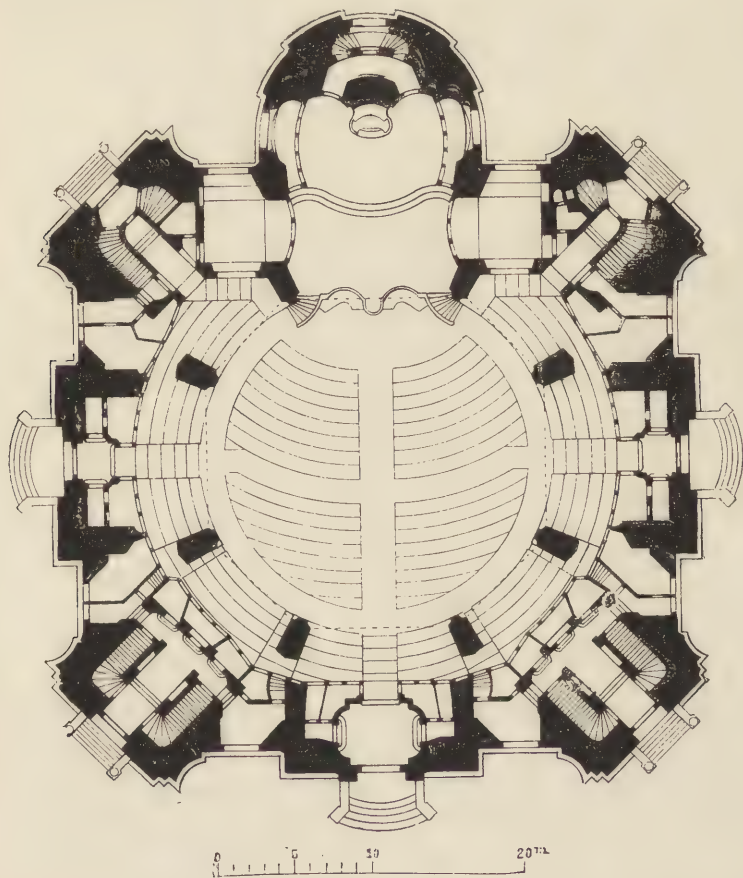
Frauenkirche zu Dresden. Grundriss.
